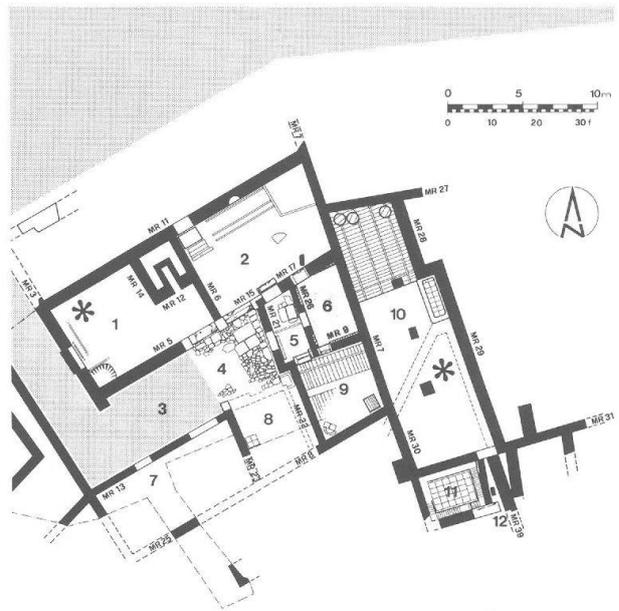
Detailgrundriss des Schmidmatt-Areals in Kaiseraugst mit eingezeichneten Probenentnahmestellen (Sterne in 1/Keller West und in 10/Werkhalle). M. 1:500.
